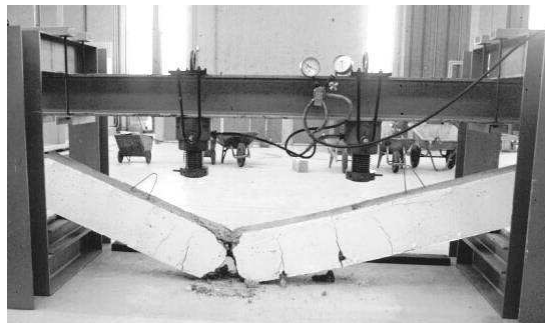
Rupture d'une poutre en flexion (cas du béton)
